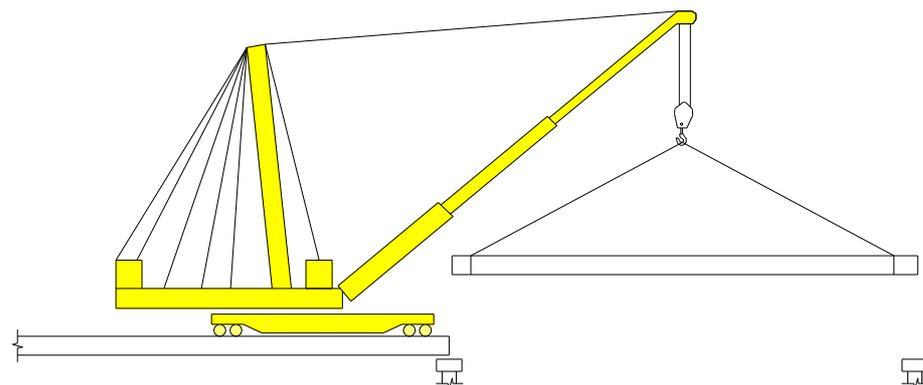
Варианты принципиальных схем монтажа разрезных балочных пролетных строений:
